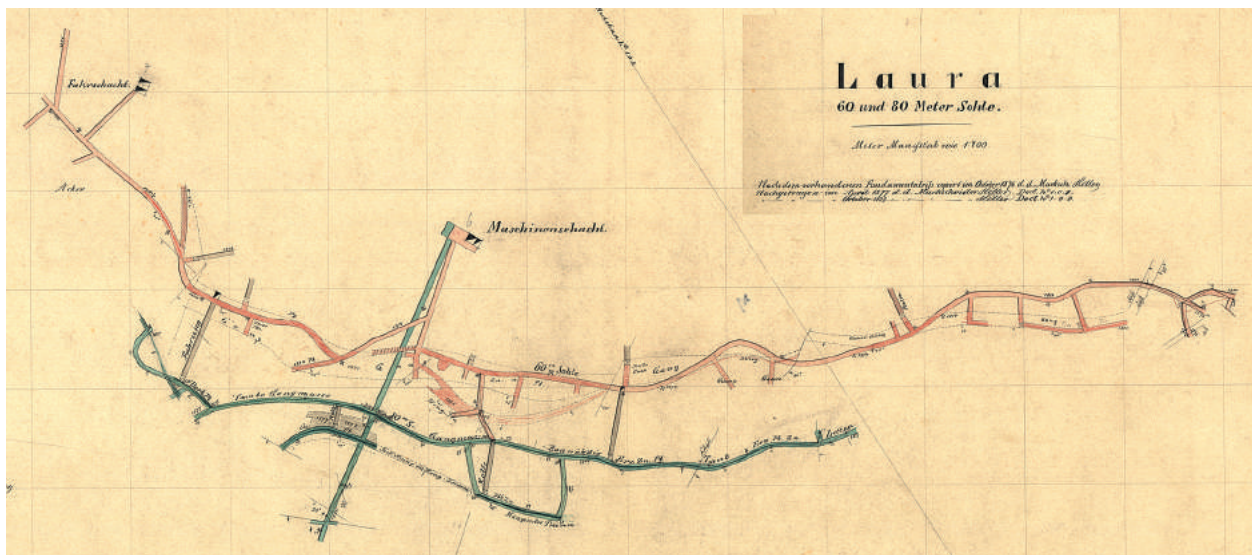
Grundriss von der 60- und 80-Meter-Sohle im Oktober, Stand 1877 (ABrA)
